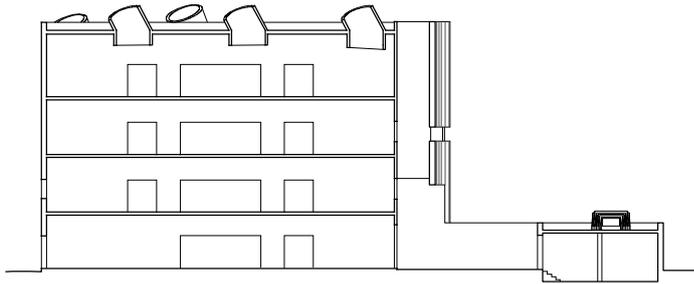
Cortes e planta da Biblioteca Universitária de Aveiro
